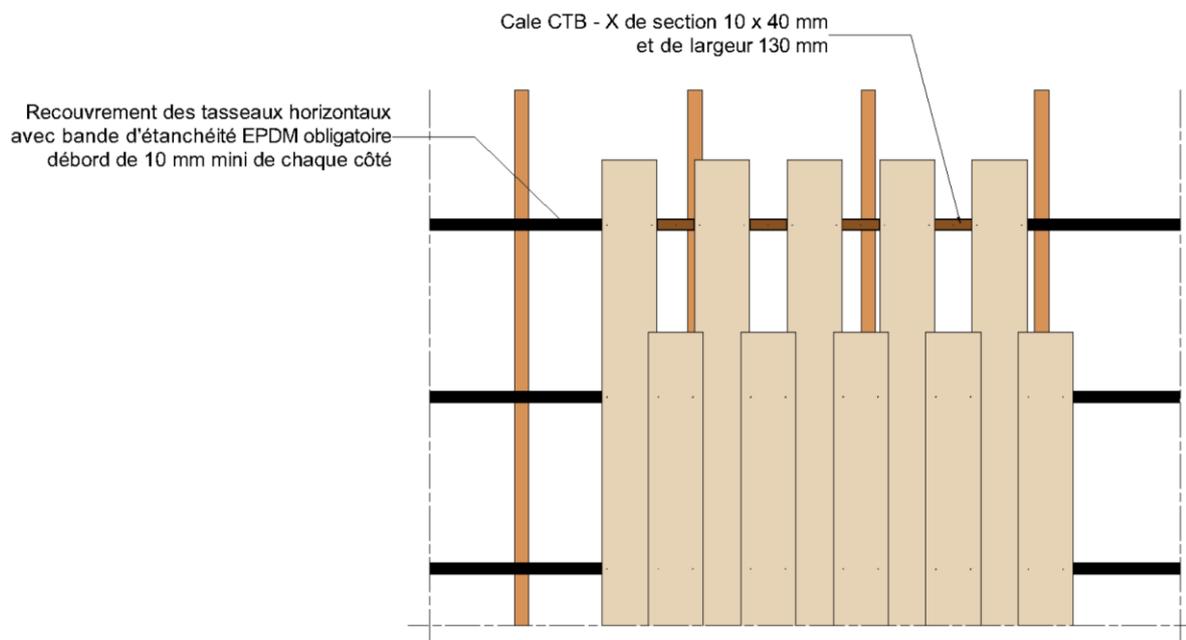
Pose verticale des lames CEDRAL LAP vue de face
